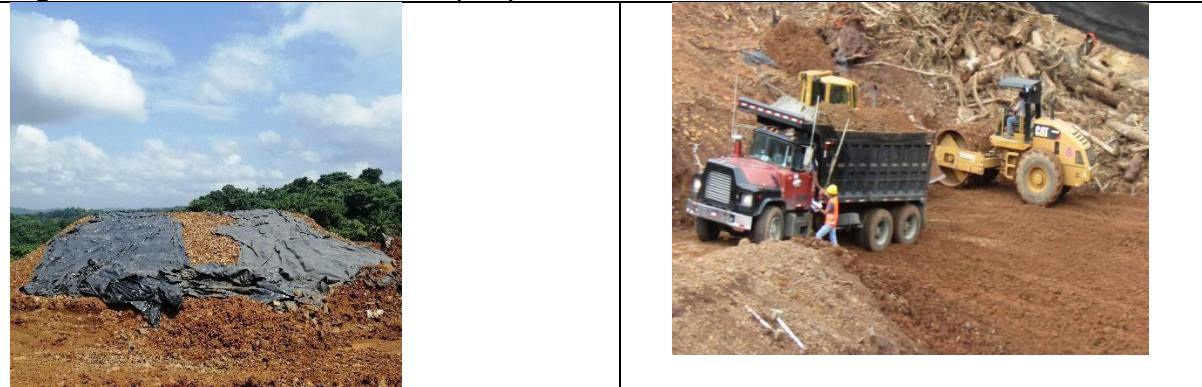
Material excedente de excavaciones cubierto con lona plástica
